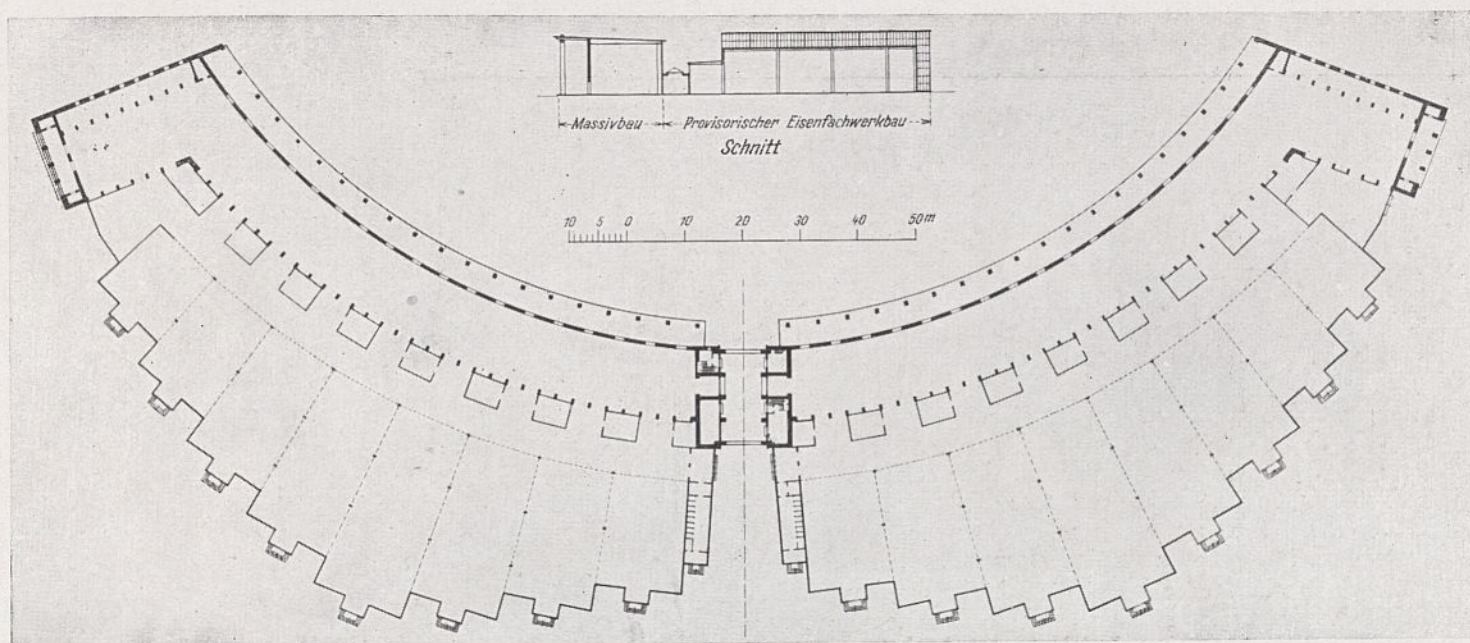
Ausstellungshallen am großen Gartenrund, Grundriß und Schnitt des Staatenhauses auf der Presseausstellung 1928.
